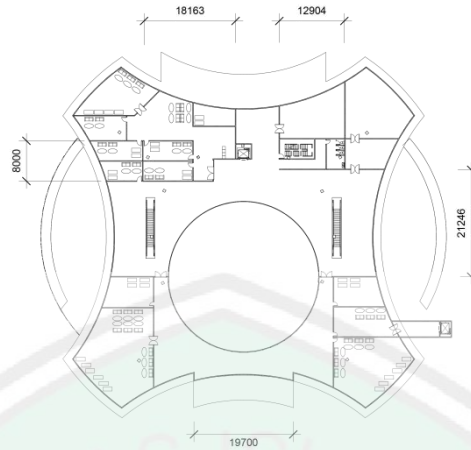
Denah Lantai 2 (Hasil Rancangan)
